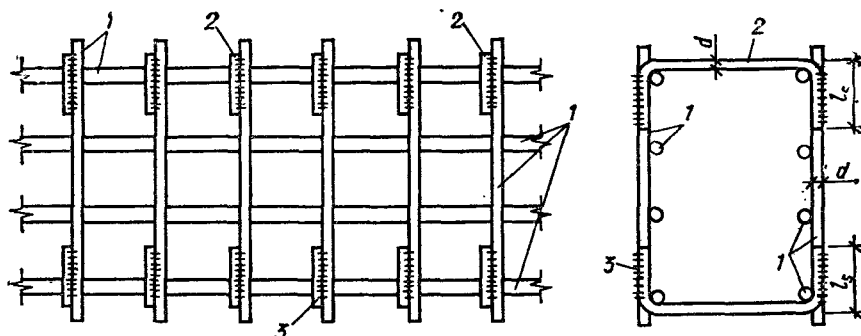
Арматурный каркас, образованный из плоских сеток, объединенных скобами при помощи дуговой сварки:
